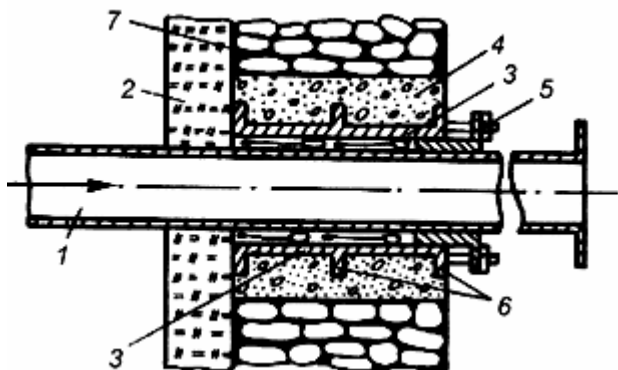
Заделка ввода в грунтах мокрых в специальных сооружениях
